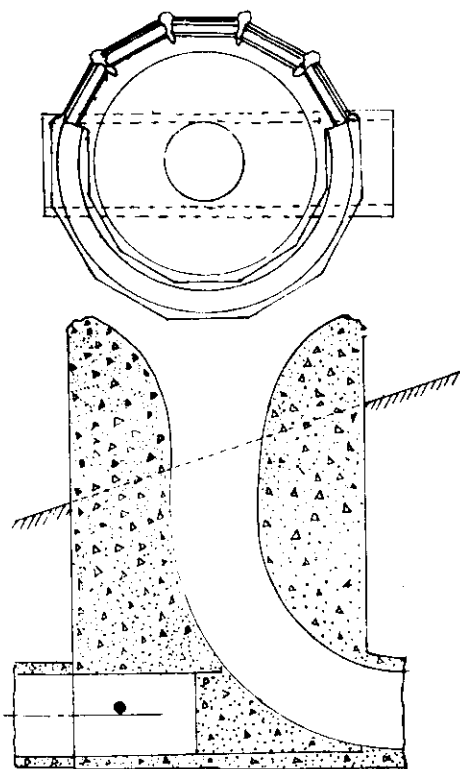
Tomada do tipo tulipa, vista em planta e em corte.
